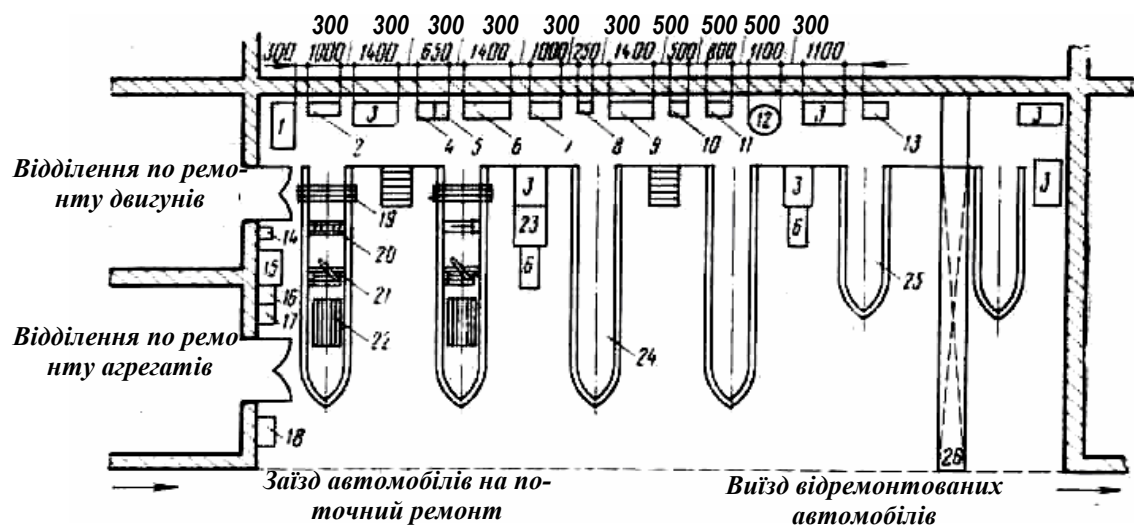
Планування робочого місця слюсаря по заміні агрегатів: 1-установка для прокачування гальм; 2 - комплект інвентарю для заправки автомобілів 3 - слюсарний верстак з лещатами; 4 - тумбочка для інструментів; 5 - гайковерт для гайок 16 мм; 6-поличний стелаж для деталей; 7 - шафа для приладів і приладднань- 8-урна для обтиральних матеріалів; 9 - стелаж для інструментів; 10 - скриня для утиля; 11-заточний верстат; 12 - металевий стелаж для дрібних деталей; 13 - стелаж для метизів; 14 - аптечка; 15 - пересувна мийна ванна; 16 - гайковерт для гайок коліс; 17-гайковерт для гайок драбин; 18 - гідравлічний підйомник; 19 -перехідні містки; 20 - гідравлічний підйомник; 21 - механізм для зняття і установки коробки передач; 22 - дерев'яні грати під ноги; 23 - візок для зняття коліс автомобіля; 24-канавка для ремонту і установки агрегатів; 25 - канавка для зняття і установки двигунів; 26 - кран-балка
